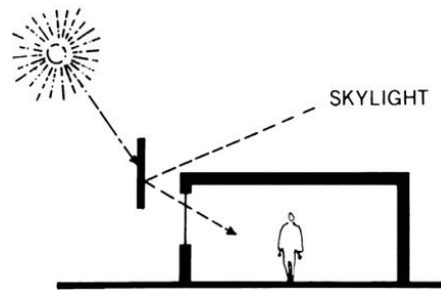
Pemasangan Elemen Peneduh Horizontal
